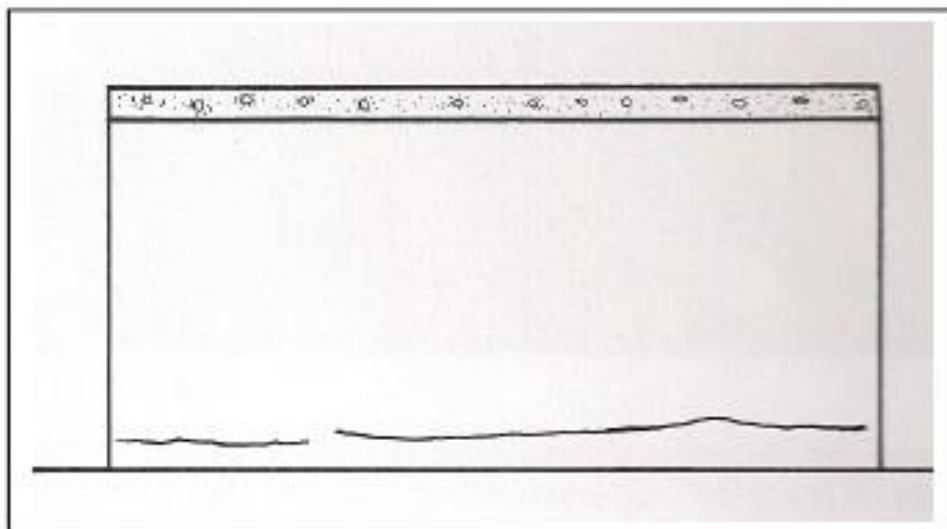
Trincas e fissuras na estrutura devido a expansão da alvenaria.
